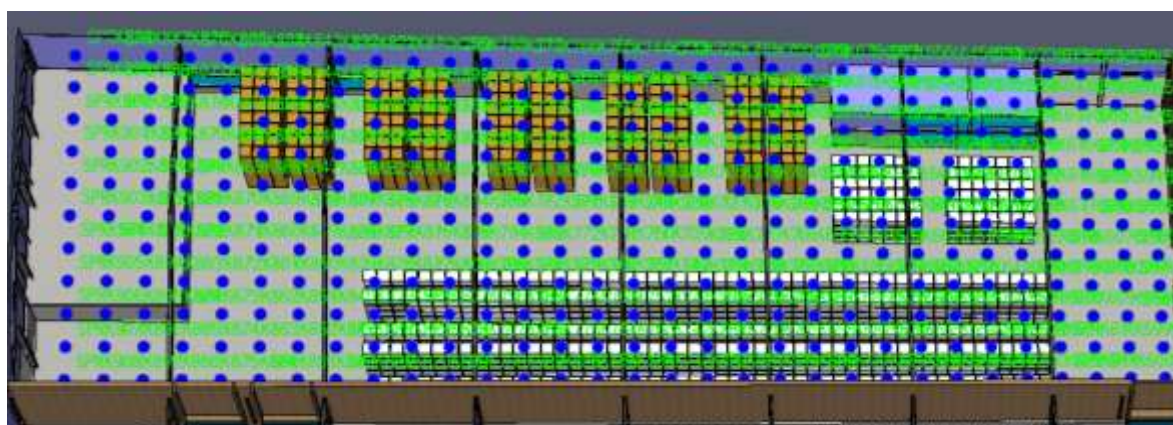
Pormenor dos sprinklers do armazém de material de embalagem 2
